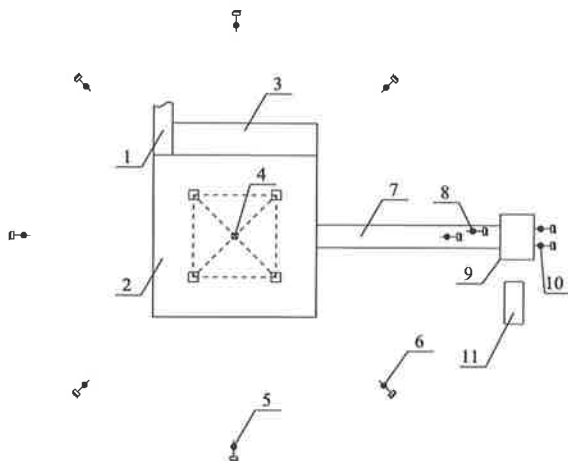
座地双摇臂抱杆分解组塔现场平面布置示意图
